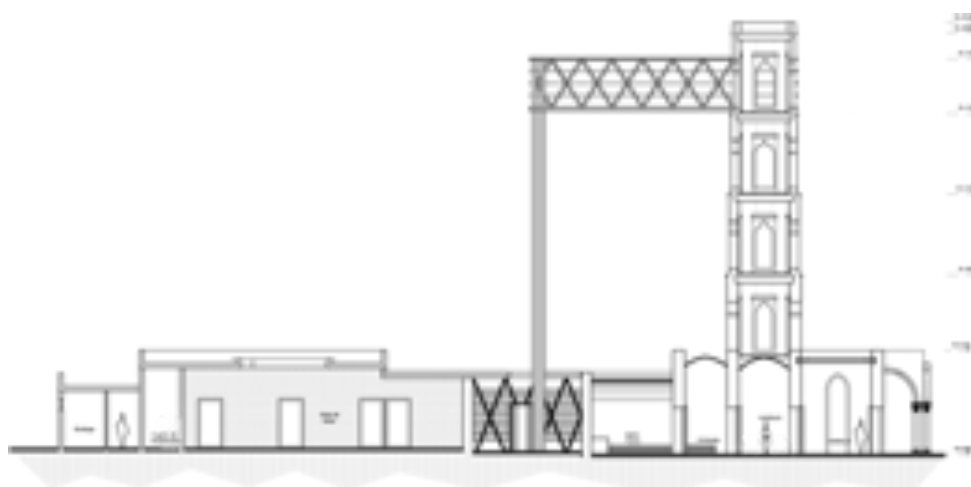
Corte arquitectónico del baño turco y la torre panóptica.
